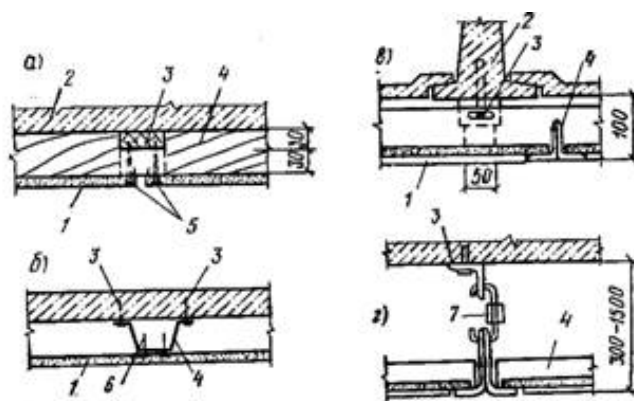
Конструктивные решения облицовки потолков при железобетонных перекрытиях
